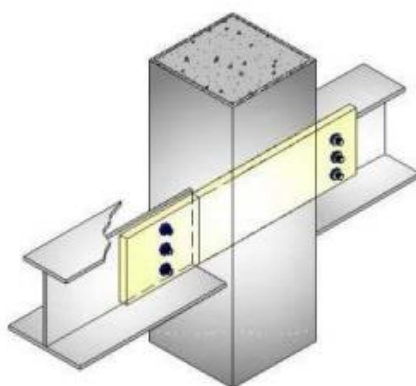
Ligação Viga-Pilar com Chapa Passante. (Santos, 2014)
